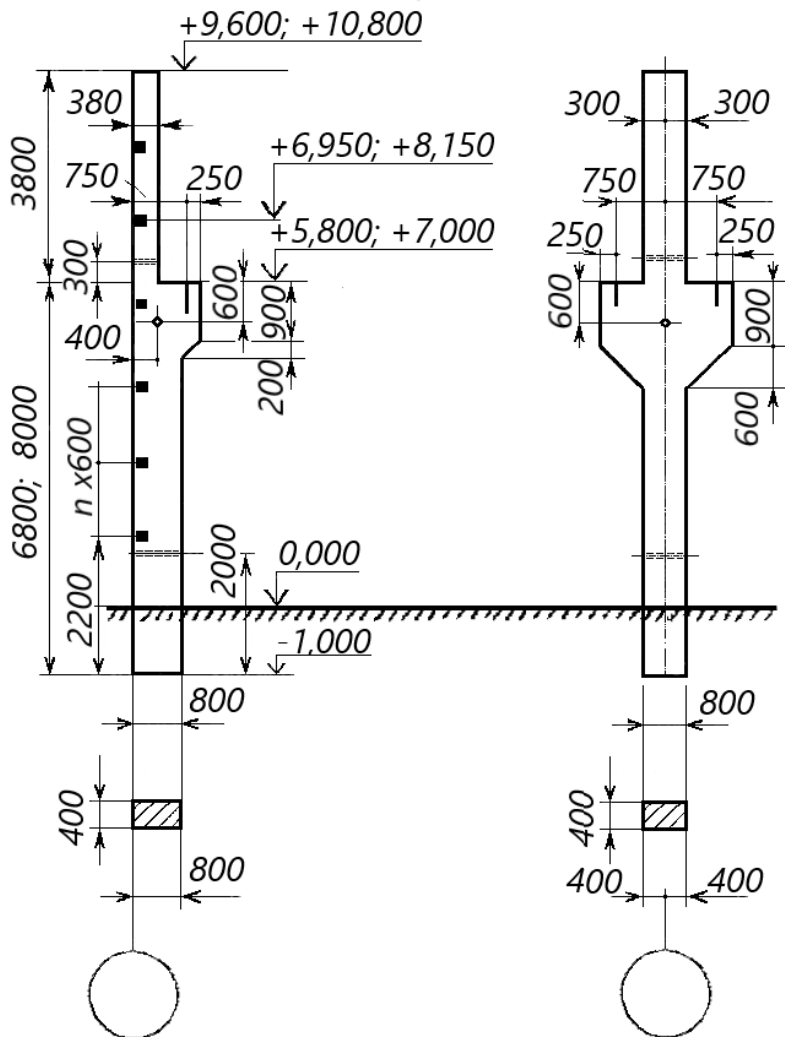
Типові колони для будівель висотою 9,6 м або 10,8 м з кранами вантажністю 100 кН або 200/50 кН, прольотами 18 м або 24 м, з кроком колон 6 м
